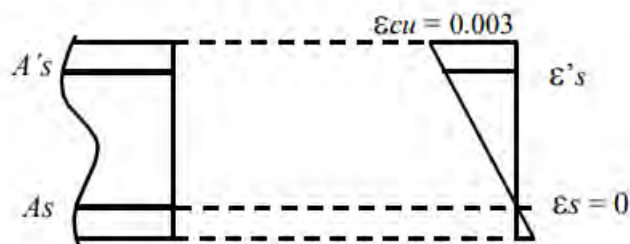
Esquema de sección de con deformación cero en acero de tracción.
